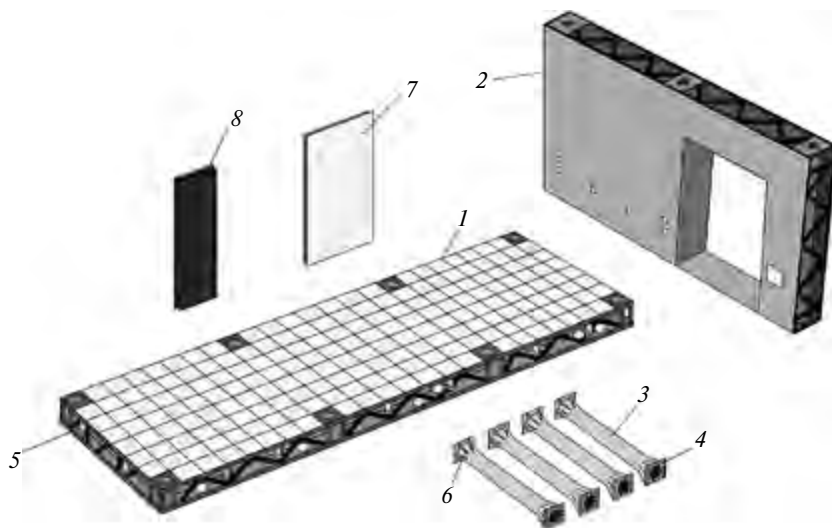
Общий вид всех элементов строительного модуля для строительства зданий: 1 – пол; 2 – несущие стены; 3 – одноуровневые несущие колонны; 4 – планки; 5 – верхний бетонный пояс; 6 – ребра жесткости; 7 – стеклопакеты; 8 – ограждающие панели
